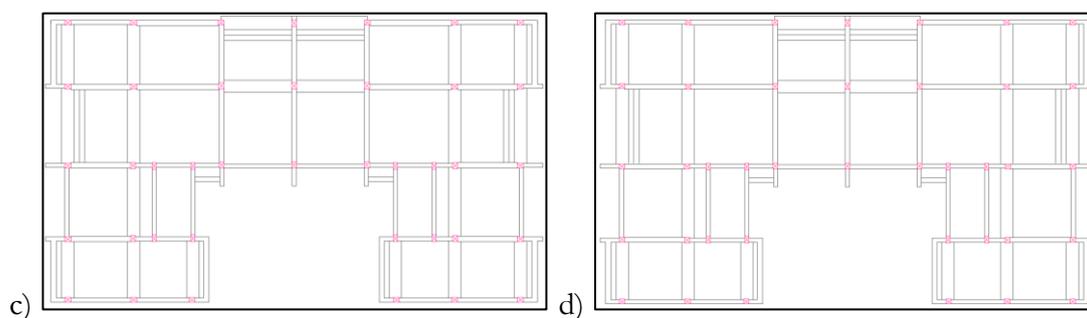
Pianta secondo solaio c) e pianta terzo solai d), ridisegnate su software CAD
